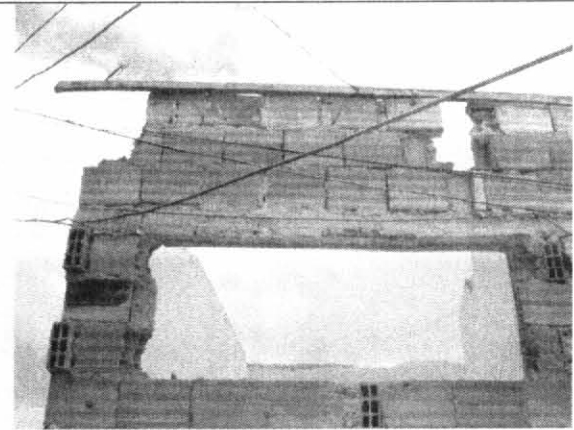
Desprendimiento de piezas de mampostería, y antepecho inestable.
